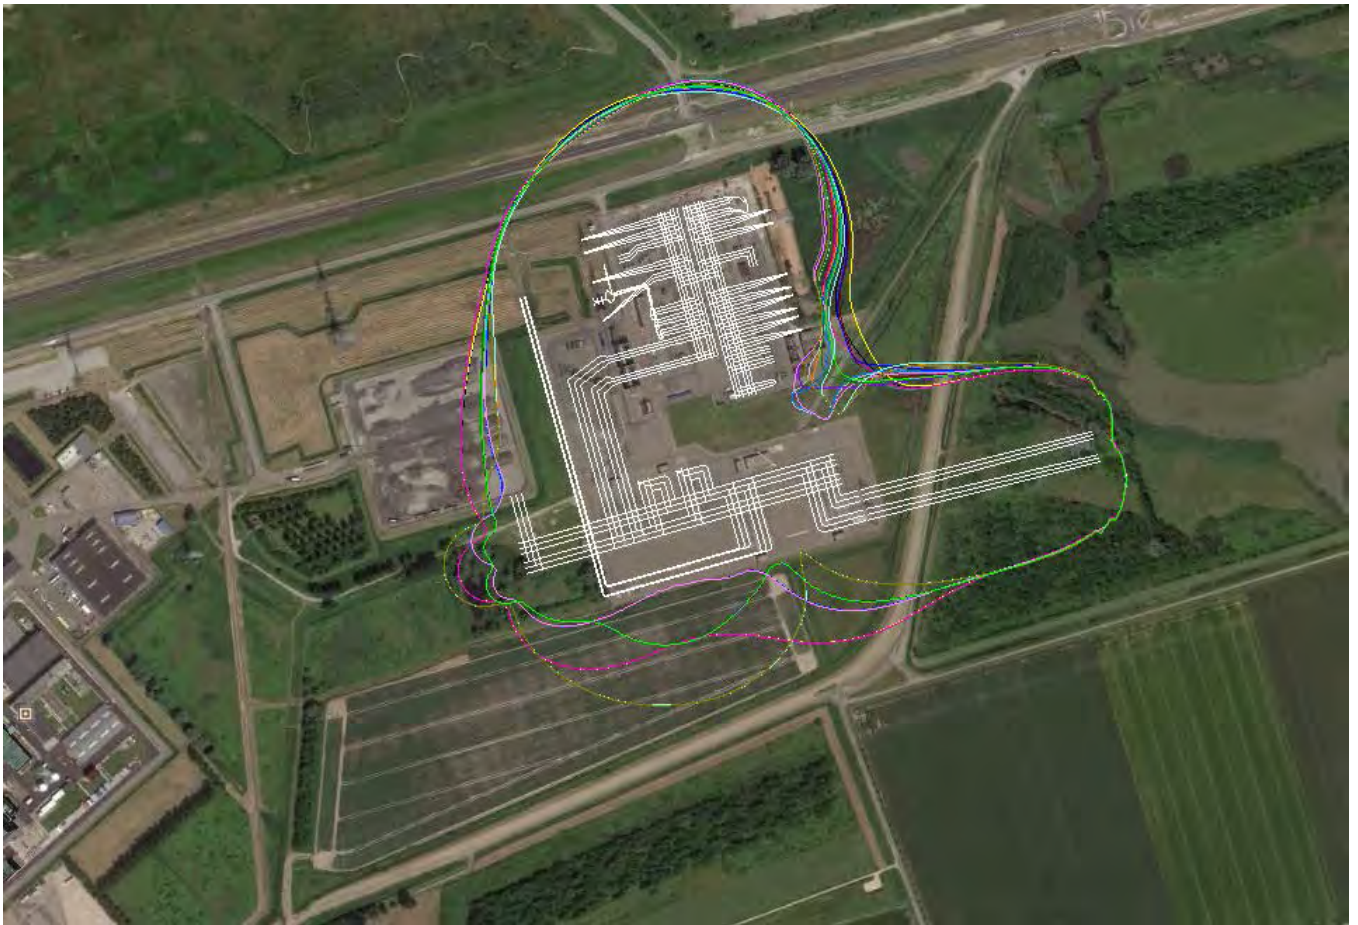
Berekende situaties van stromen door de 380 kV hoofdrails in het Net op Zee station
